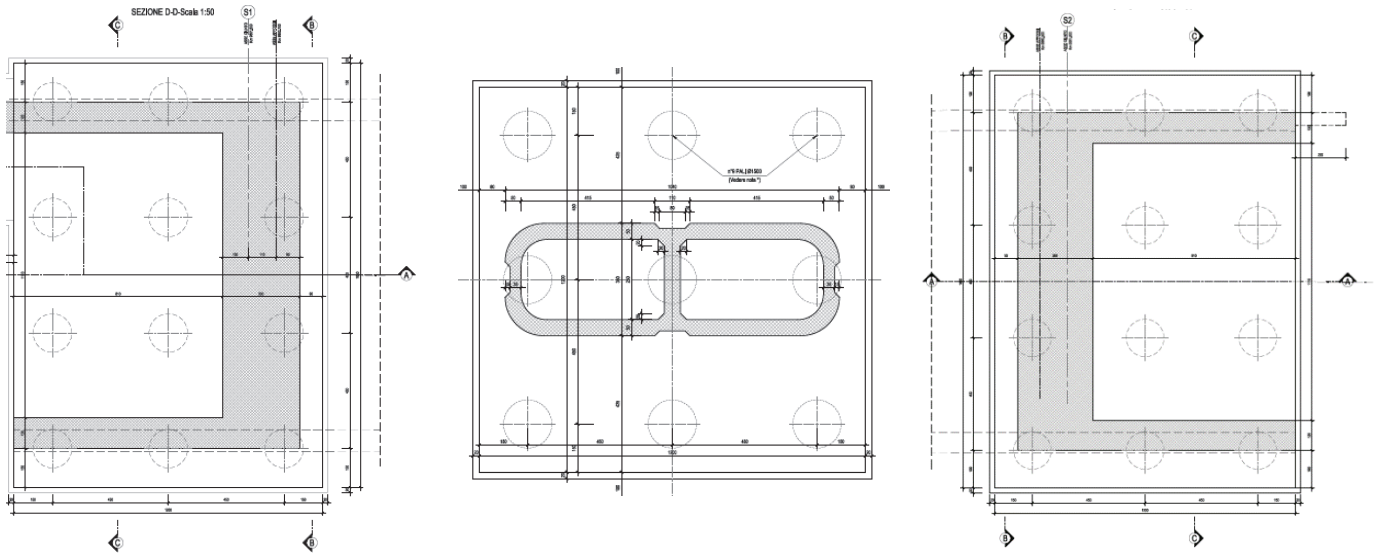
Pianta delle fondazioni delle pile e delle spalle
